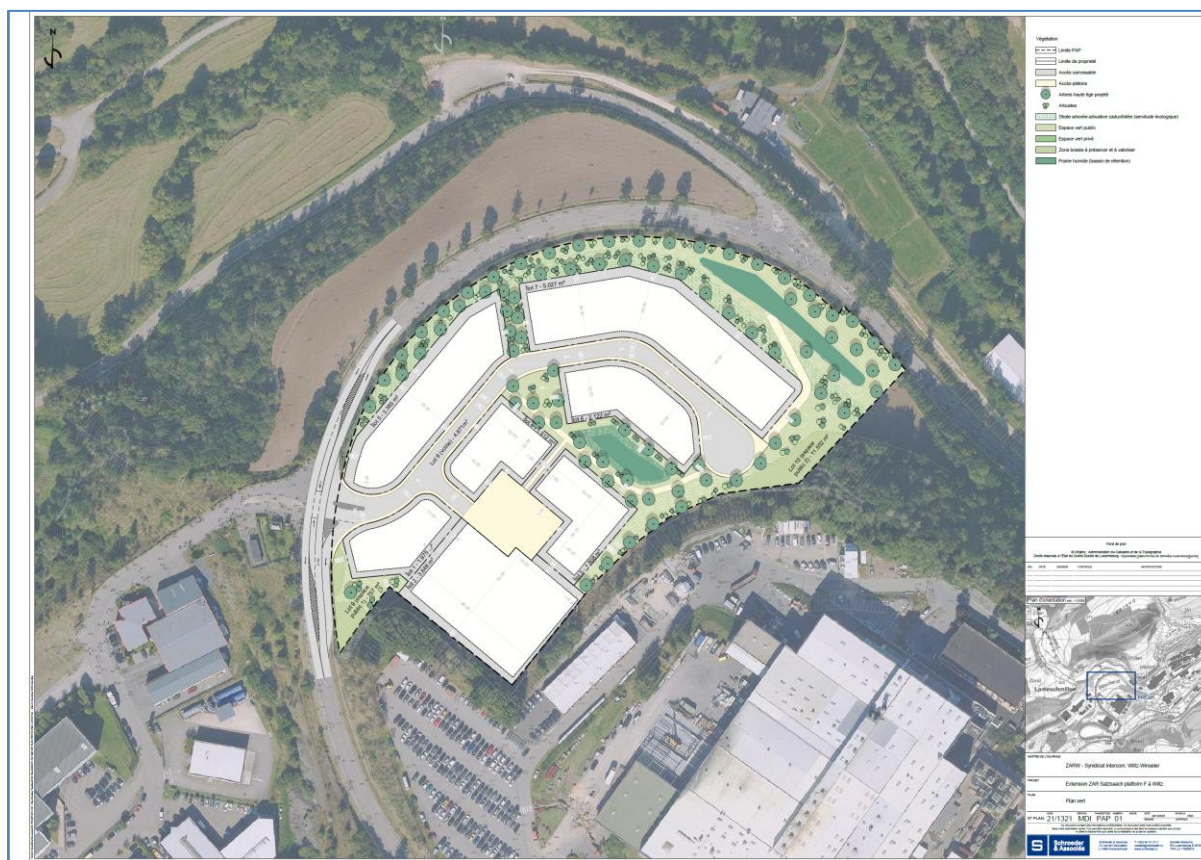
Plan vert « Salzbaach – Plateau F » (sans échelle, orientation Nord). Source : Schroeder et Associés, 2025.
